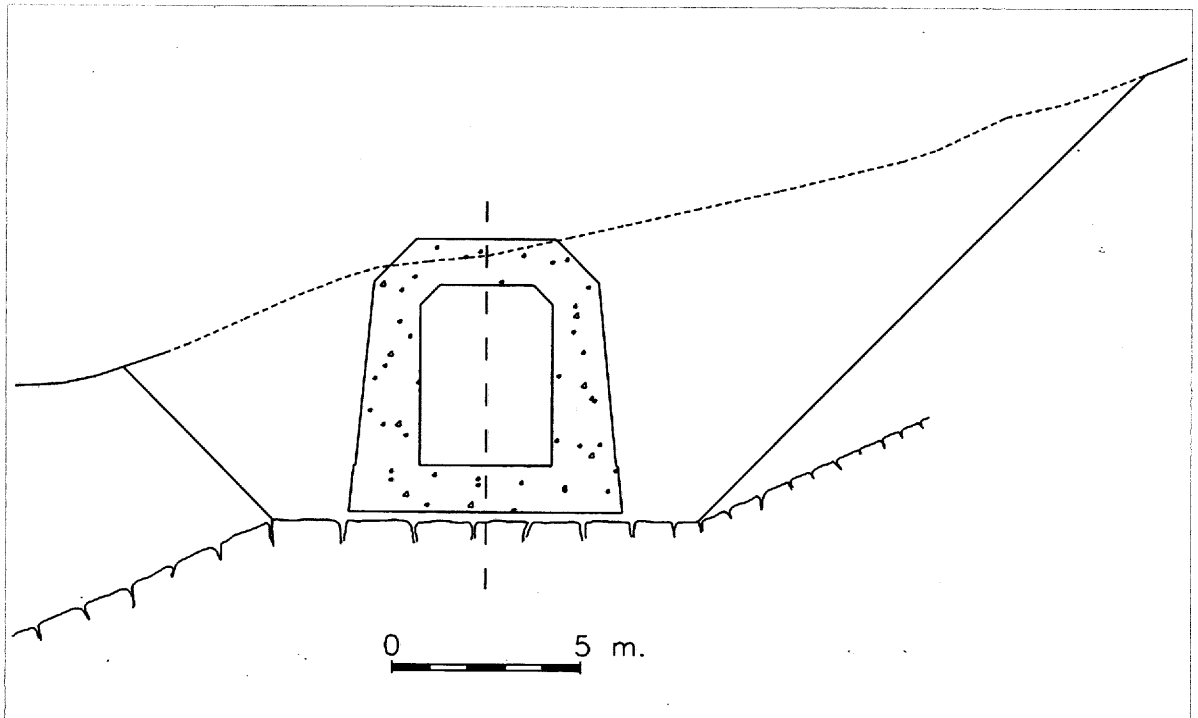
Presa de Sidi-Aich. Sección tipo del desagüe de fondo.
